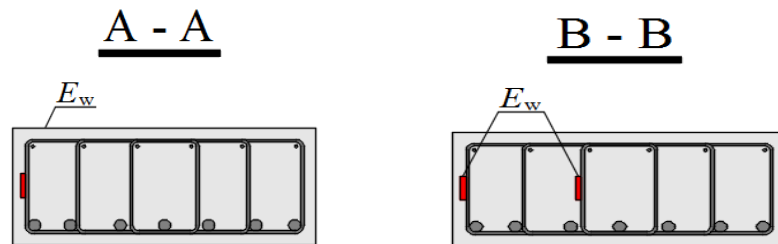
Seção transversal da viga C-3.5-0.24 instrumentada.
